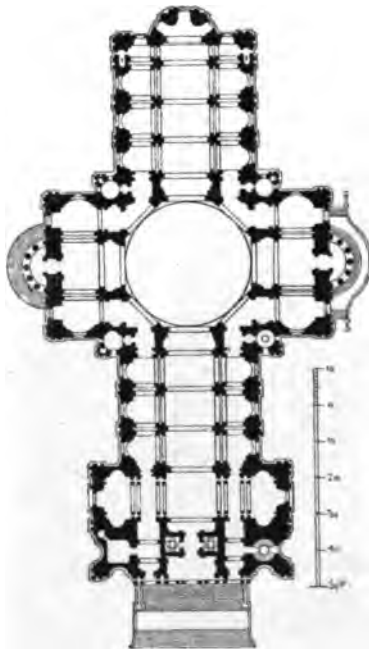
Grundriss der Pauls-Kathedrale zu London
